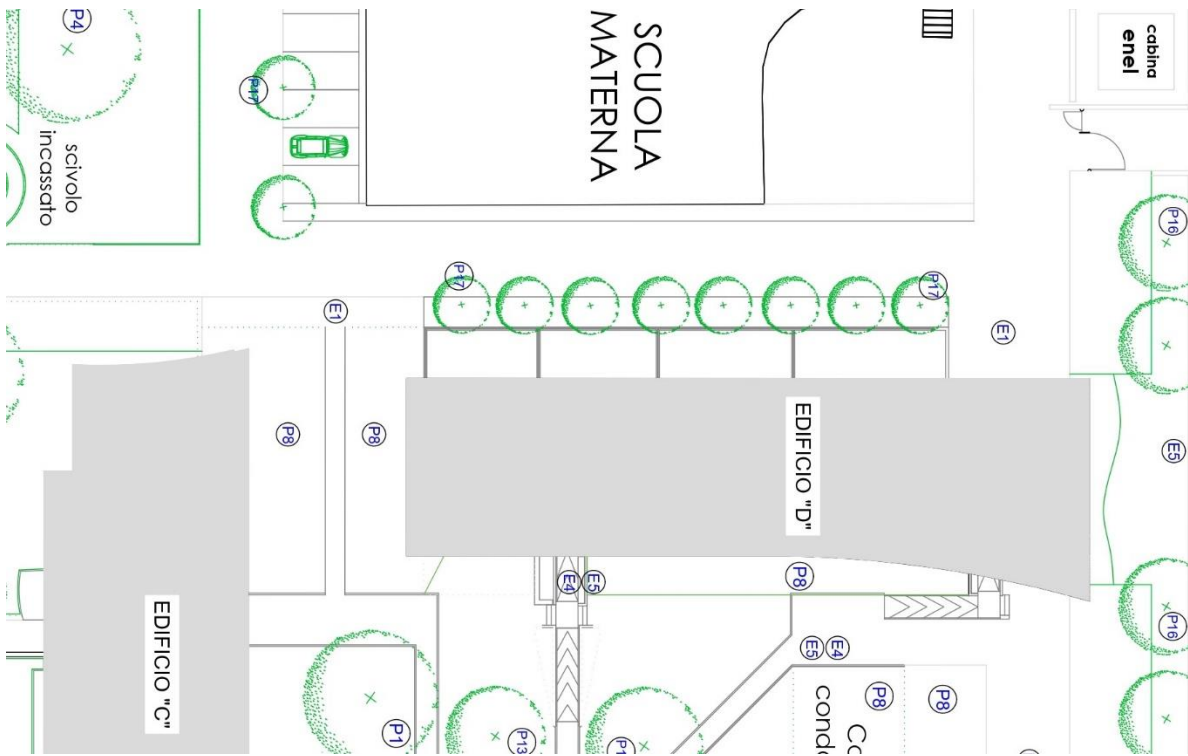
POSIZIONE DELL'EDIFICIO D SECONDO IL PROGETTO ORIGINARIO
